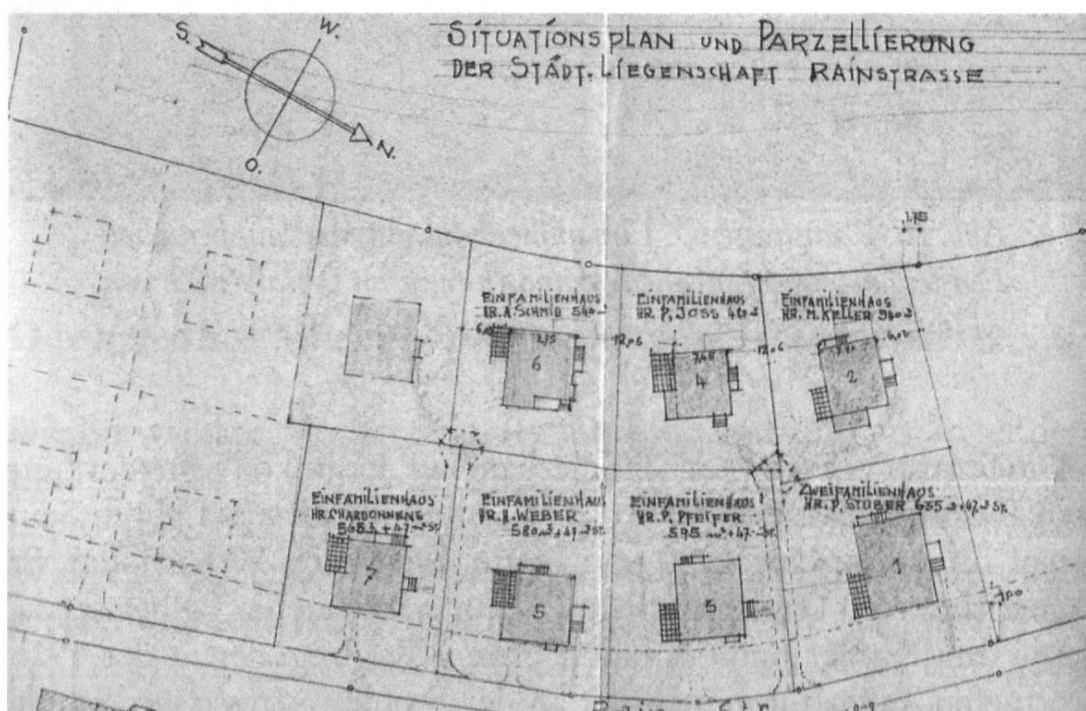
Situationsplan und Parzellierung der «städt. Liegenschaft Rainstrasse», erstellt durch Fritz Emch, Architekt, 1937, betr. Rainstrasse 75–89. Plan in Privatbesitz. (Aufnahme S. Brändli.)
